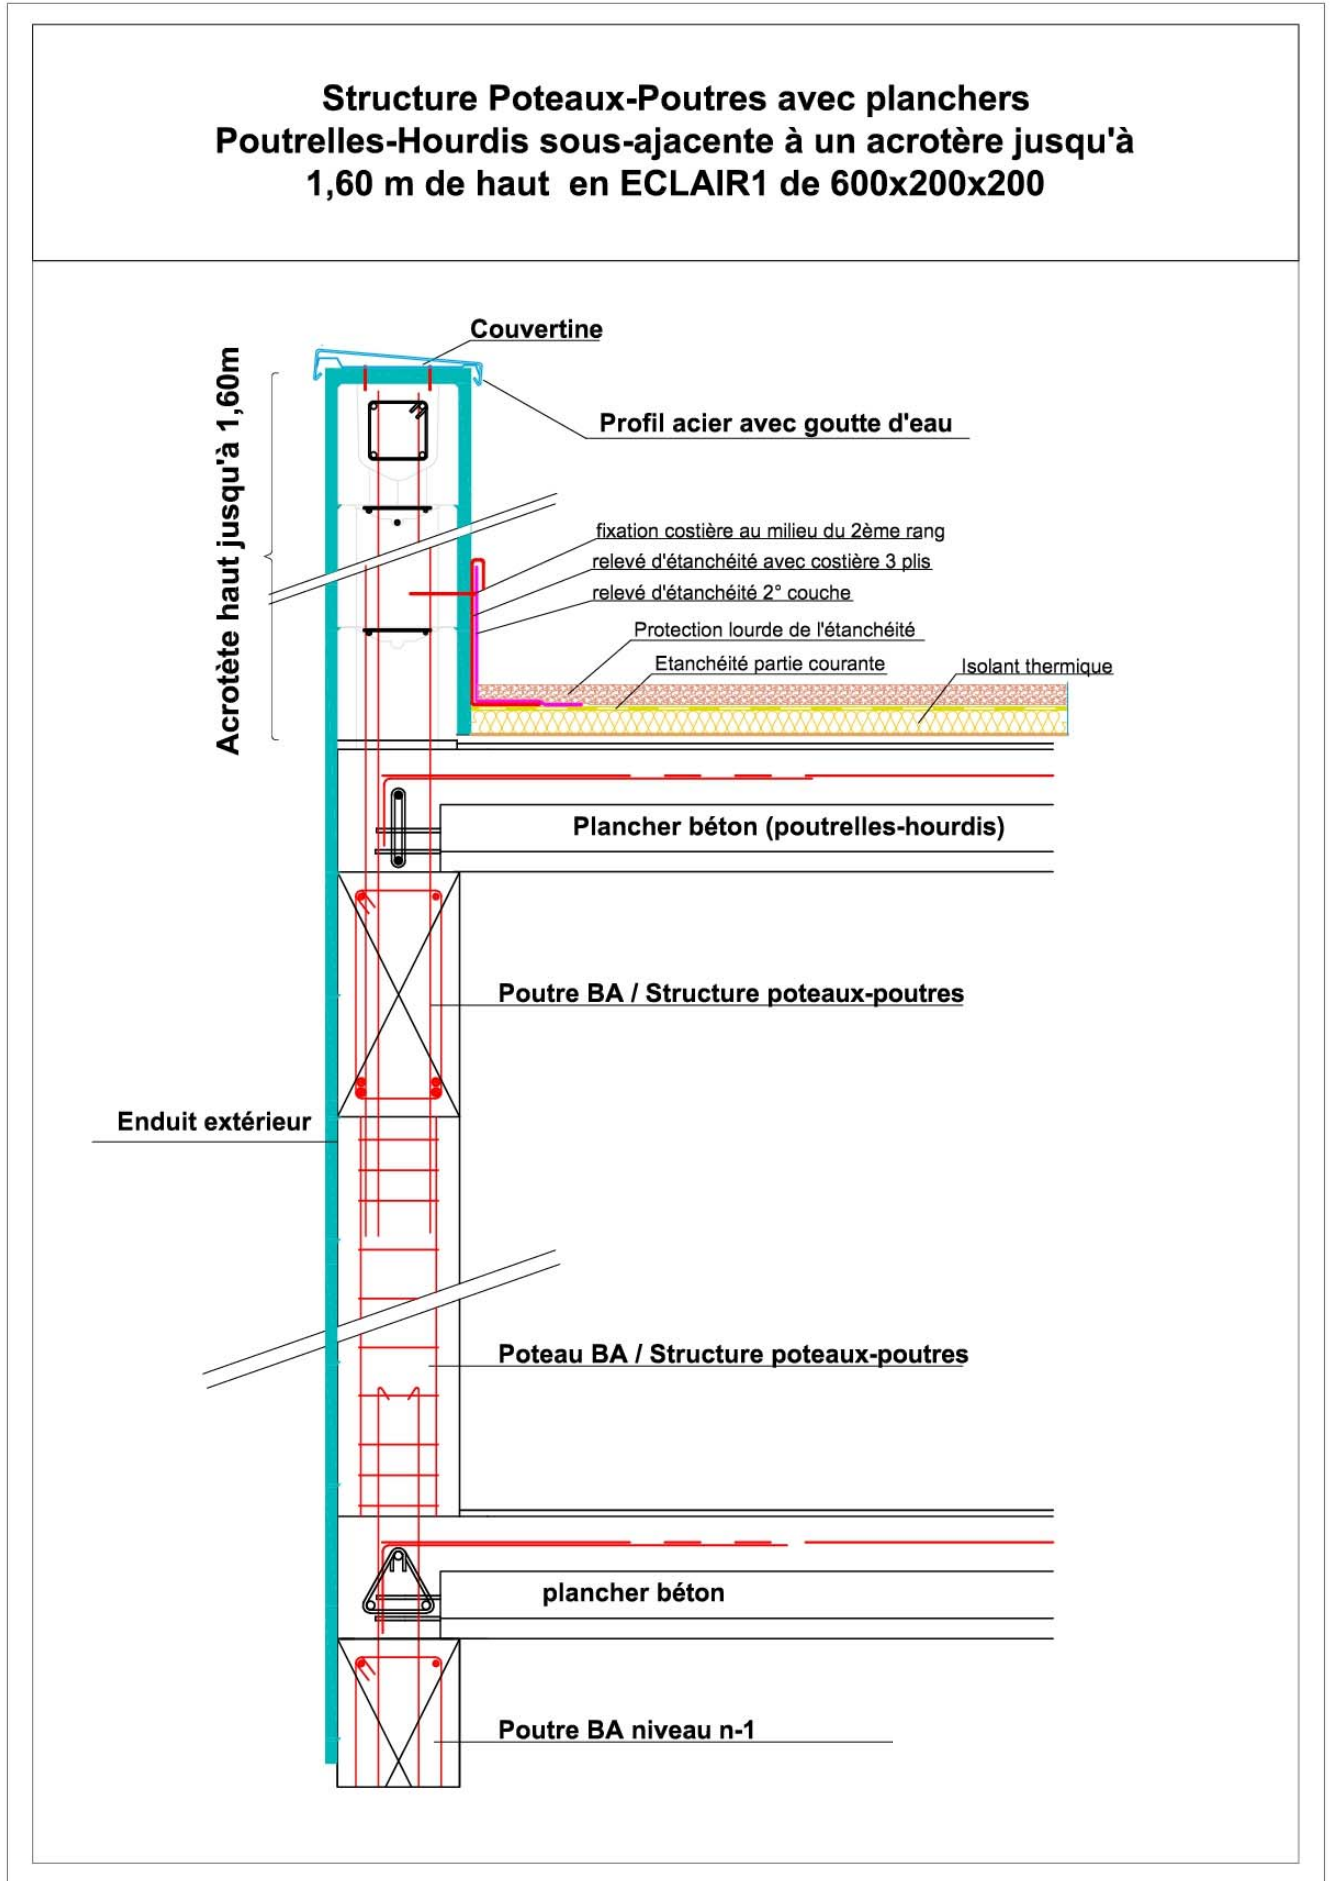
Paroi et plancher en béton armé et acrotère en blocs ECLAIR 1
